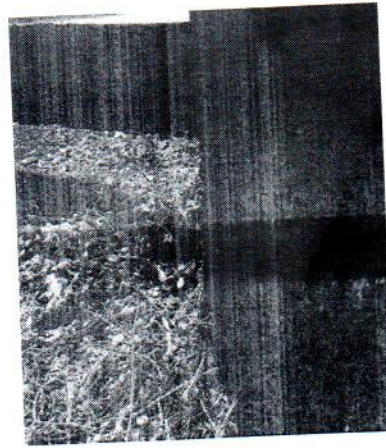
"Bicheiras" de Concreto, com armadura exposta
